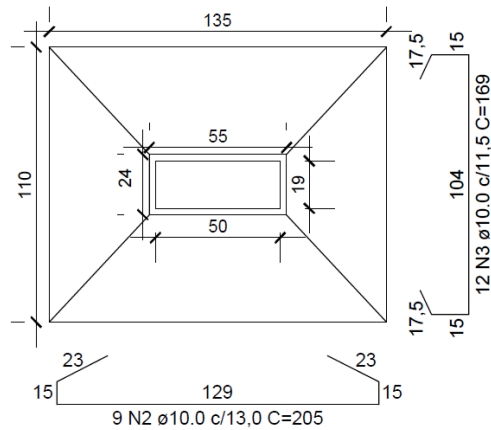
Detalhamento transversal da sapata do pilar com menor carregamento (casa de alto padrão)
